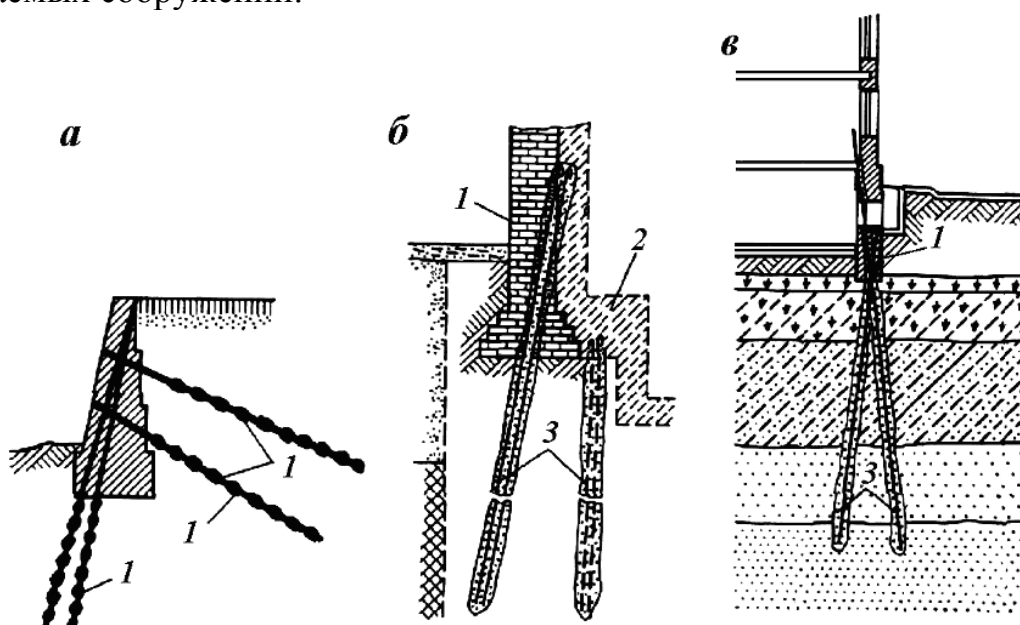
Усиление фундаментов зданий и сооружений буроинъекционными сваями:
